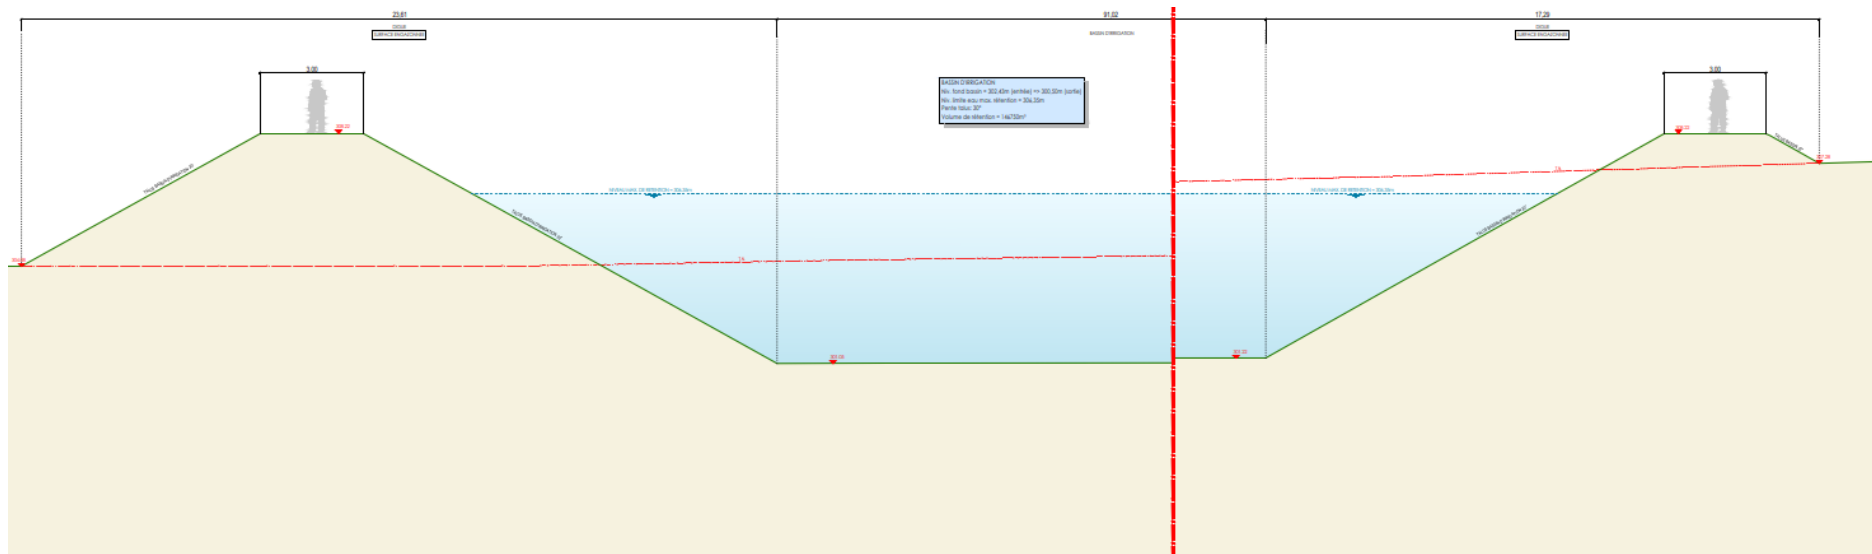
Auszug aus dem Plan „Concept d'assainissement – Coupe A-A“ (Variante D) (LUXPLAN S.A. Stand 01/2020): Der maximale Abstand zwischen der Beckensohle und der Dammkrone beträgt hier 7,17 m
